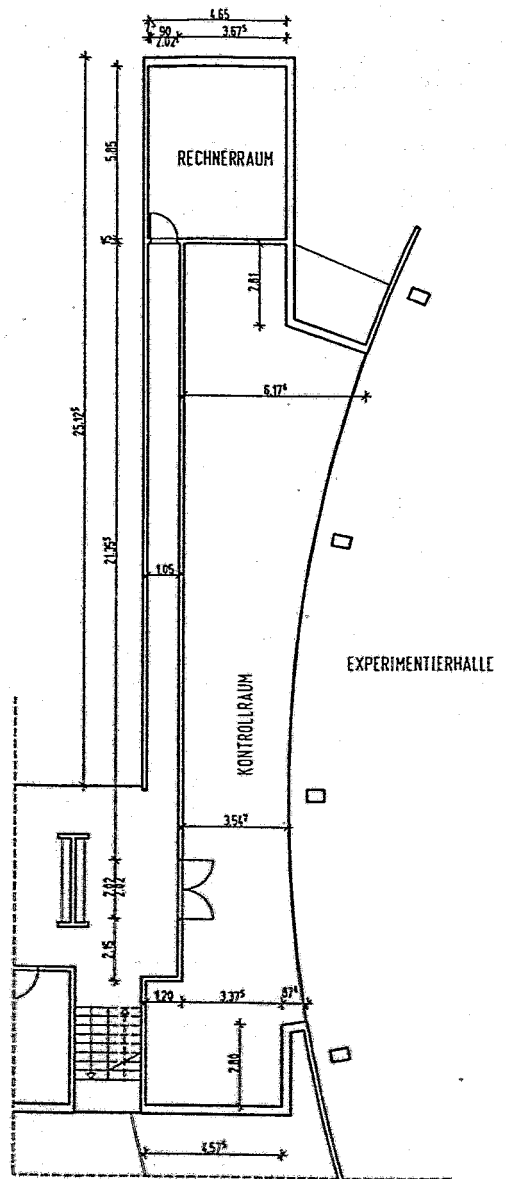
Grundriß des Bereiches Kontrollraum / Rechner
